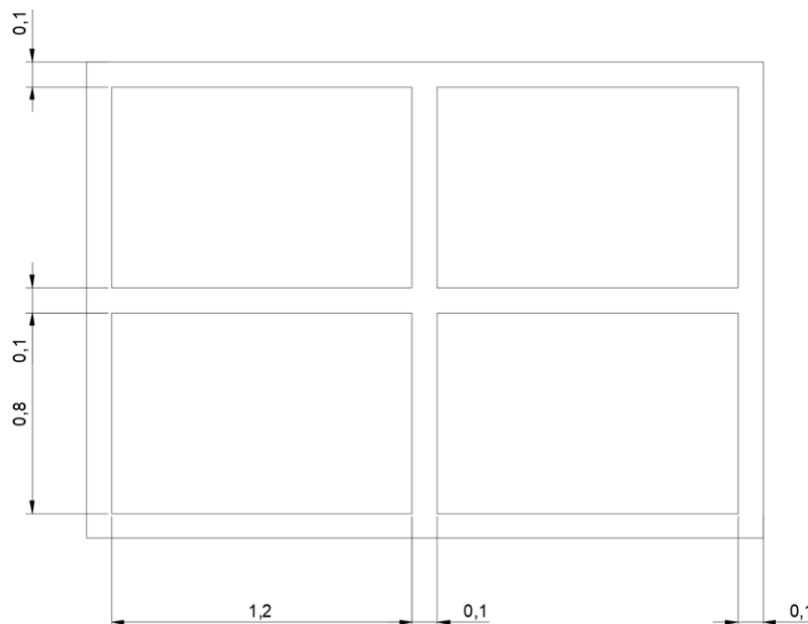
Vista en planta de las dimensiones y separación entre cada bloque. (Elaboración propia)
